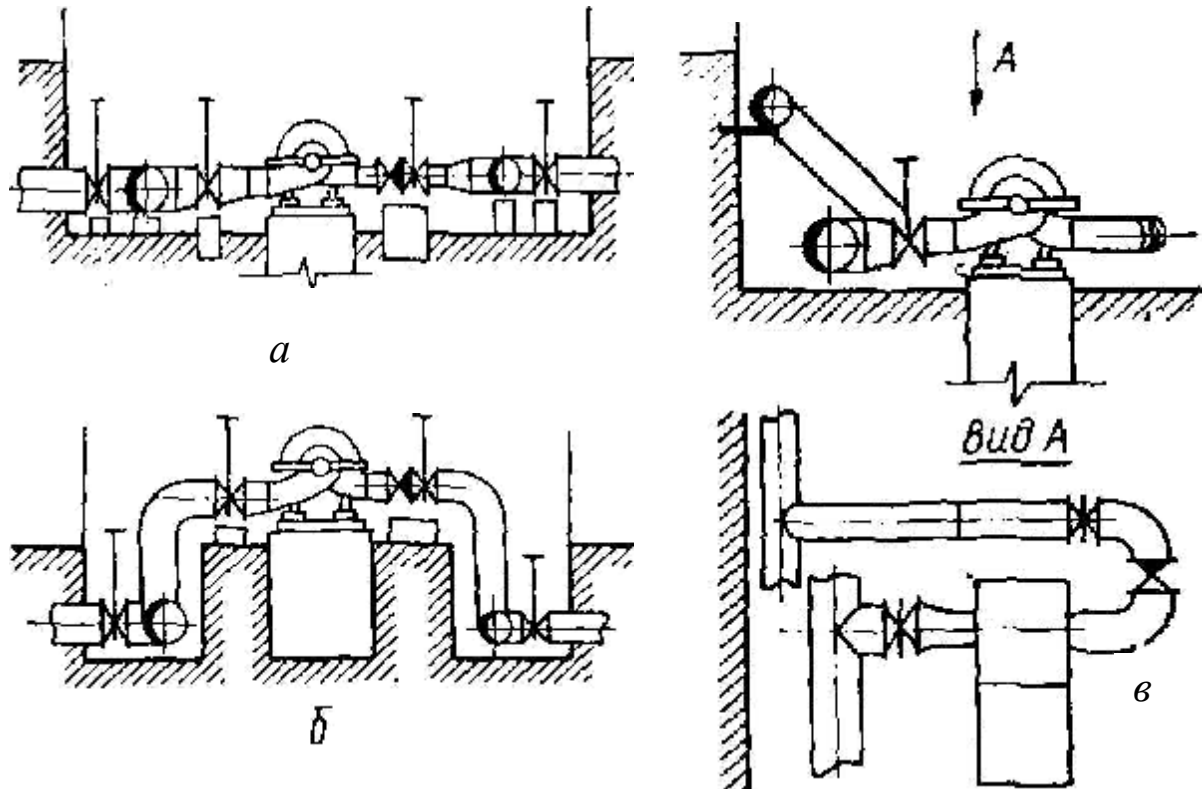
Основные схемы размещения трубопроводов на станциях II подъема:
